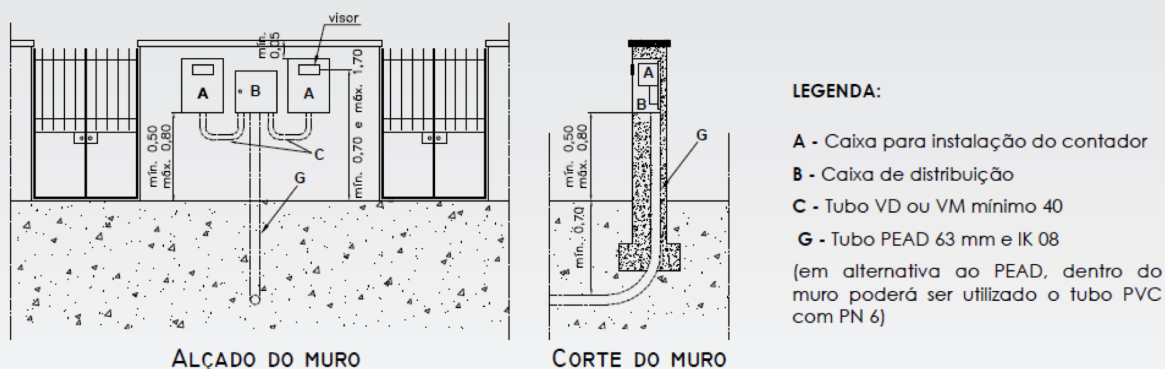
Ligação a partir de rede subterrânea de moradias geminadas, em banda ou bifamiliares dotadas de muro
